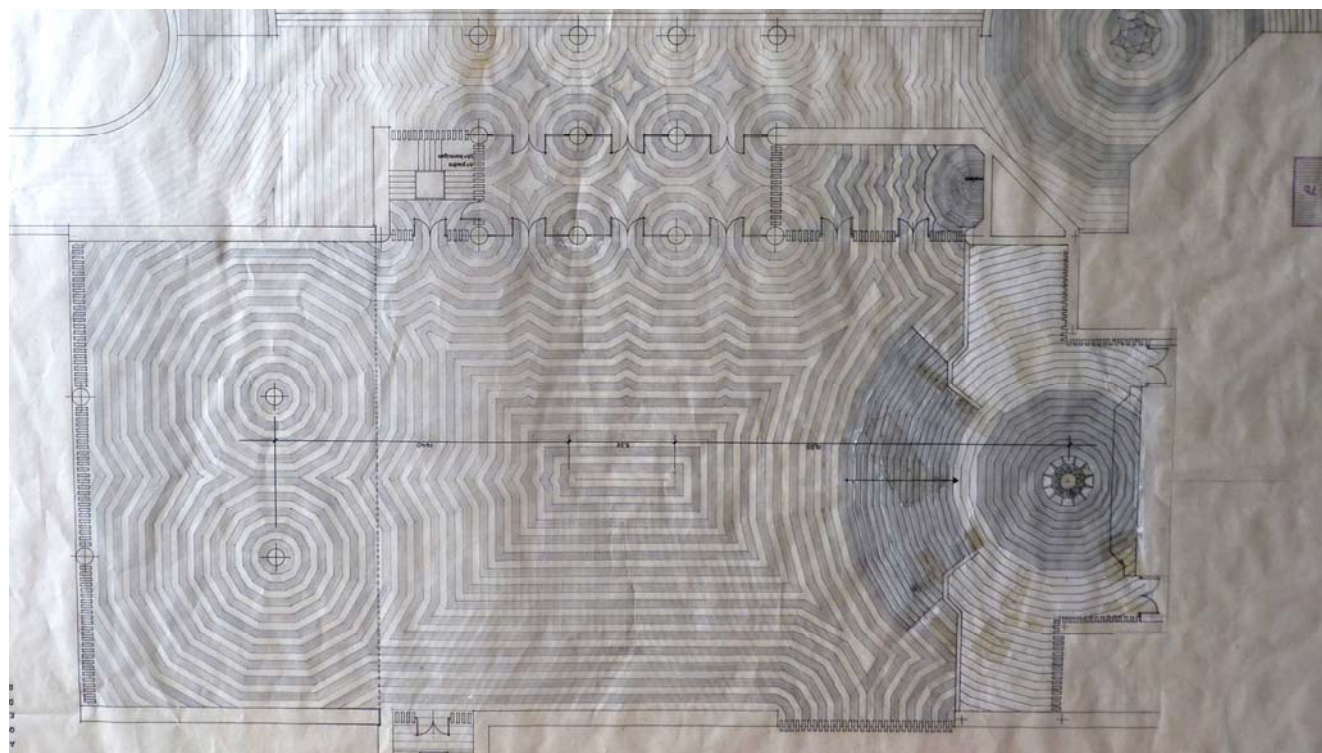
Plano de pavimento interior. Archivo de Heliodoro Dols Morell.
